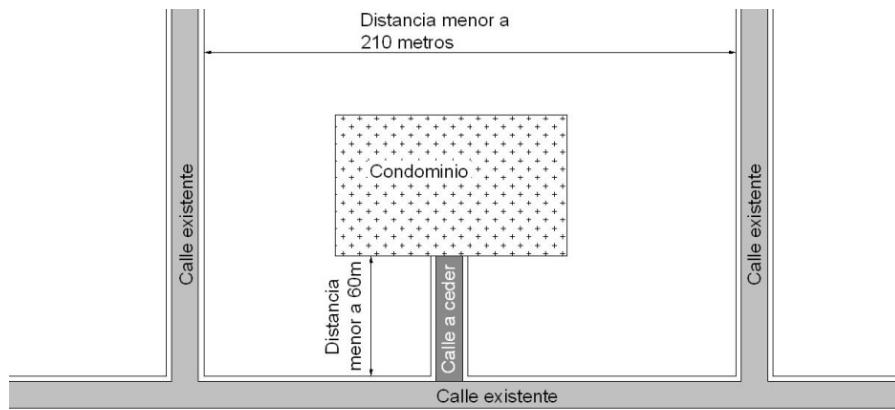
Casos 1 y 2 para Condominio dentro de cuadra con tres calles perimetrales
